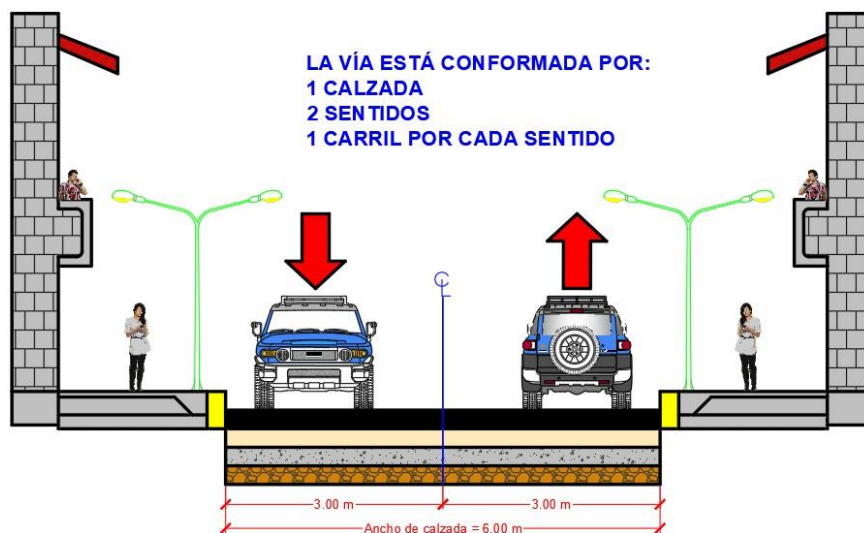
Dimensiones de del ancho de calzada de la vía
